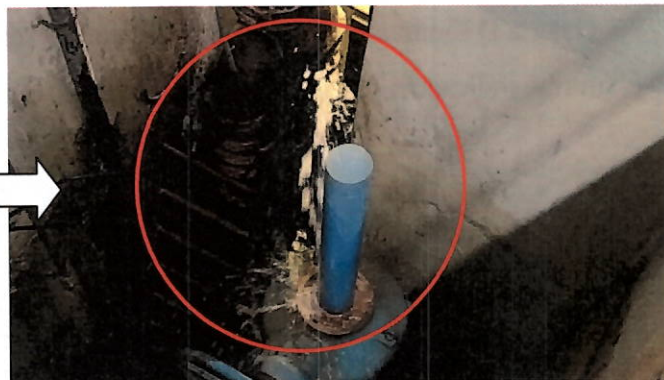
Galeria C – foto ampliada de válvula com vazamento.
